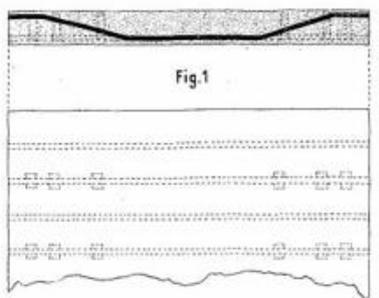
Losa de hormigón armado Hennebique (Seco de la Garza, 1900)
